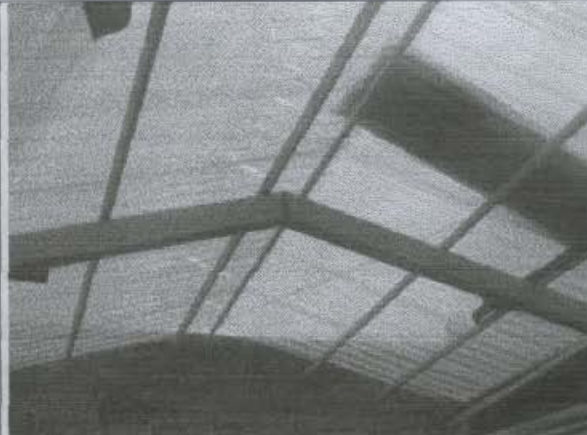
Cubierta en estructura metálica y teja plástica (estructura nueva)
